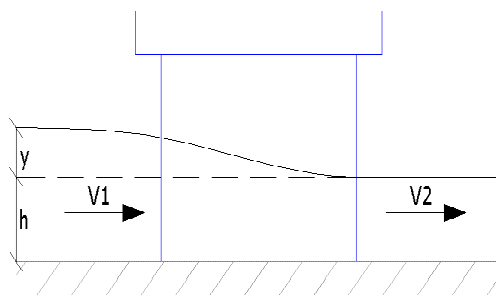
Sobre-elevação (y ou h_c) formada pela contração devido ao pilar da ponte.
